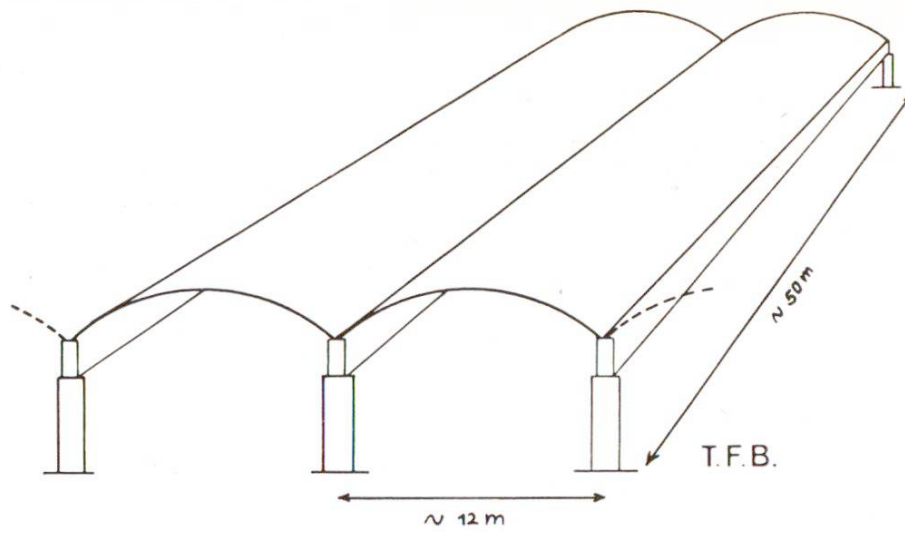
Tonnengewölbe auf vorgespannten Balken (Bus-Garage). (Concrete and Constructional Engineering, 47, 8, (1952))
